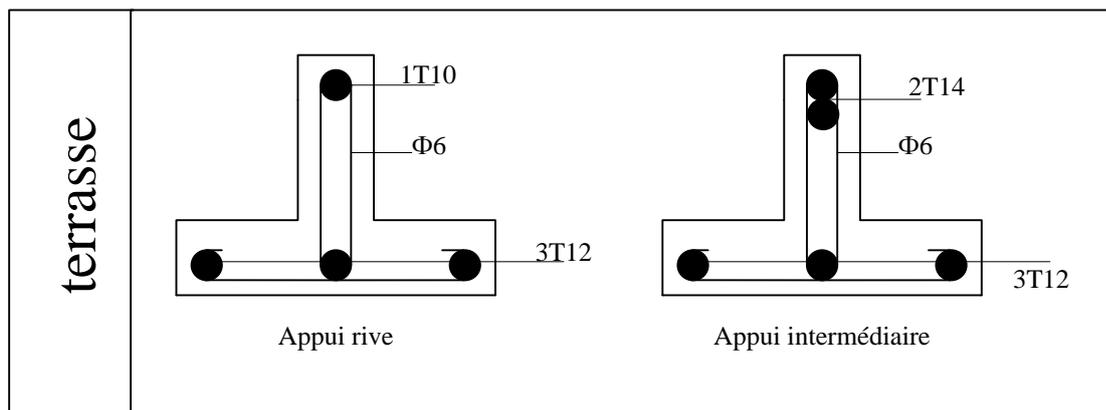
dessin de ferrailage la poutrelle du plancher terrasse.
